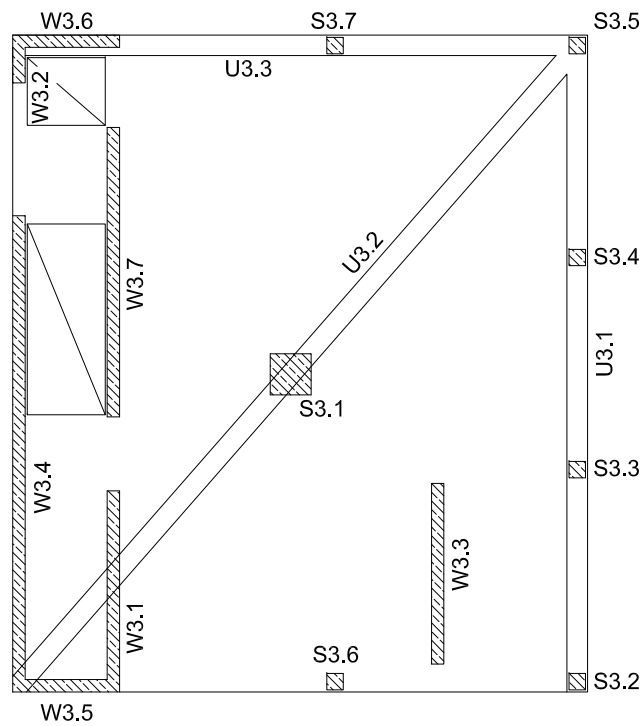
Bürohaus X: Grundriss 2. Obergeschoss [Lie09]
